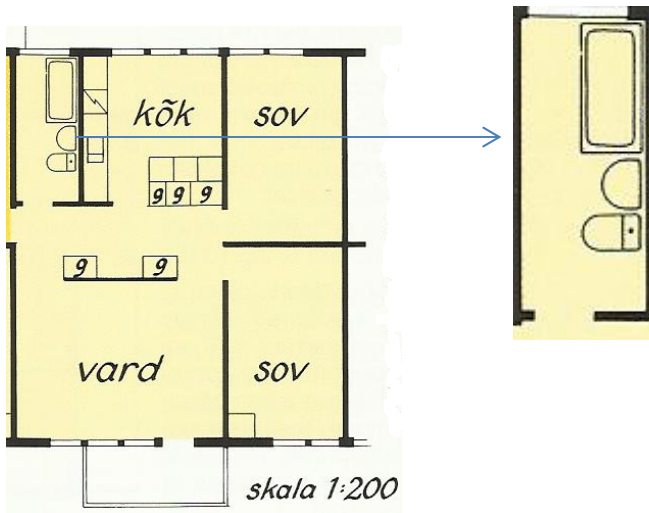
Exempel planlösning Lamellhus, betongstomme.
